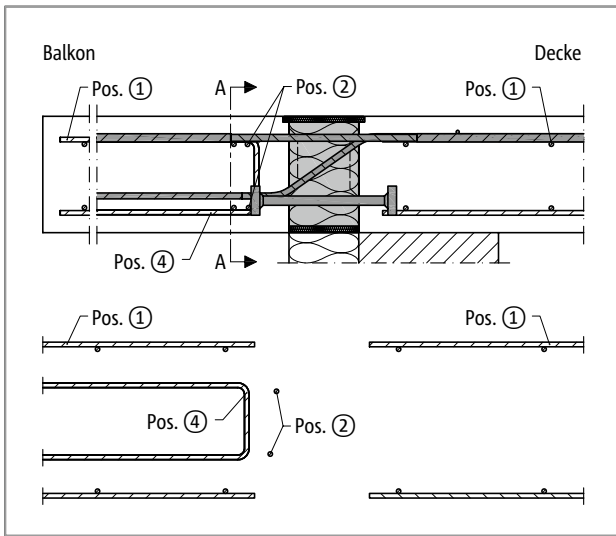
Schöck Isokorb® XT Typ K-M11: Bauseitige Bewehrung bei direkter Lagerung
